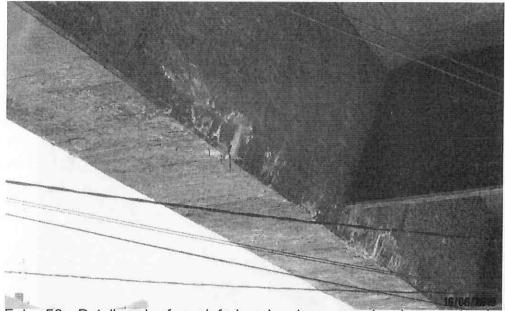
Detalhe da face inferior da viga com desplacamento de concreto e com eflorescência.
